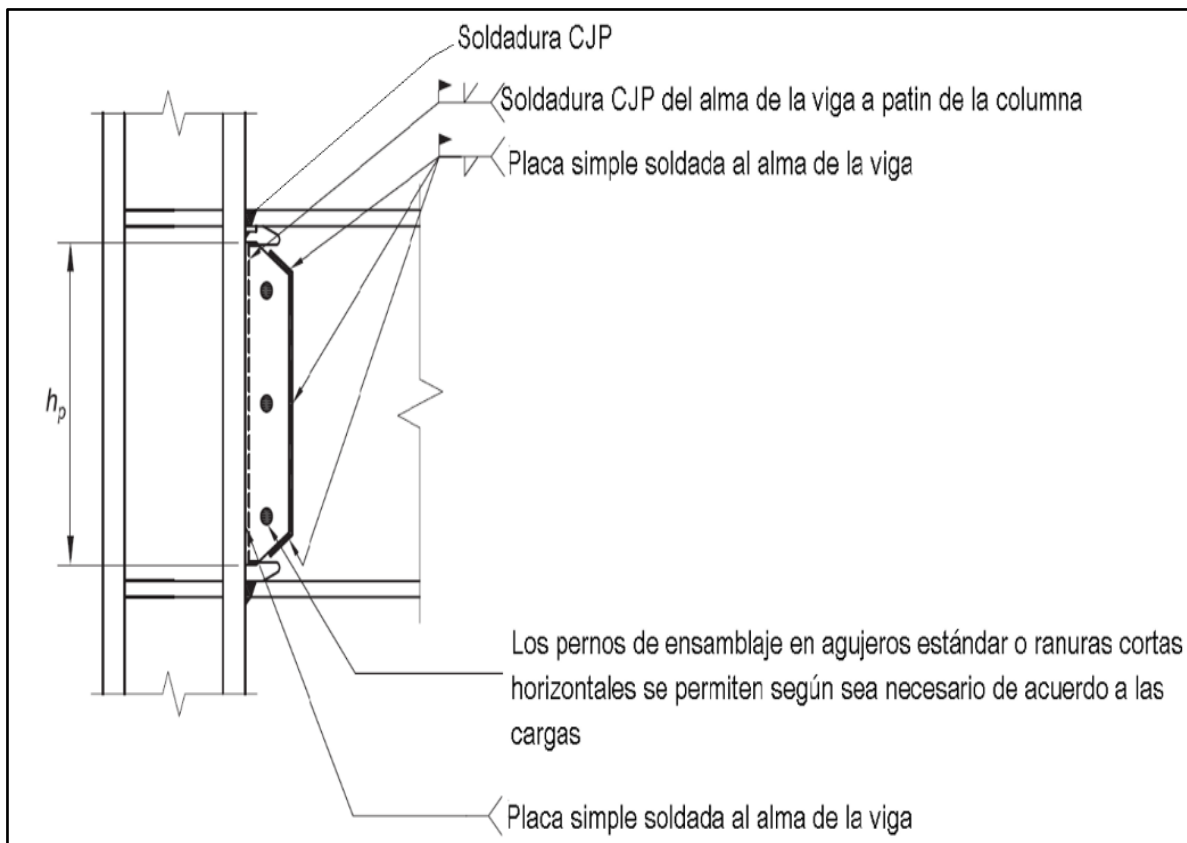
Detalles de la conexión del alma de la viga al patín de la columna. AISC358 (2016)
